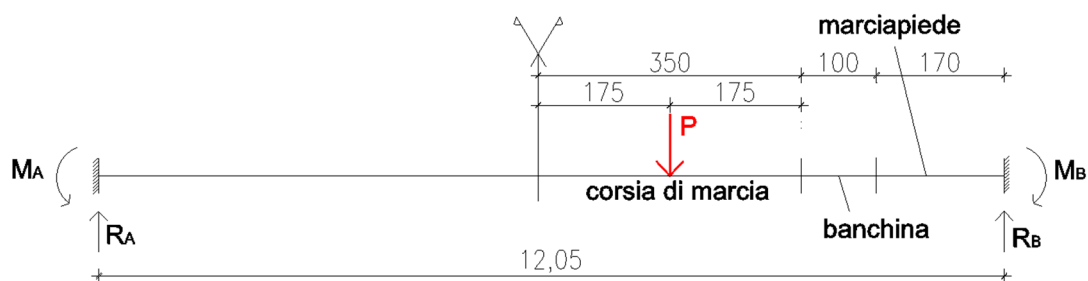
Carico asse P viaggiante, schema sezione trasversale
